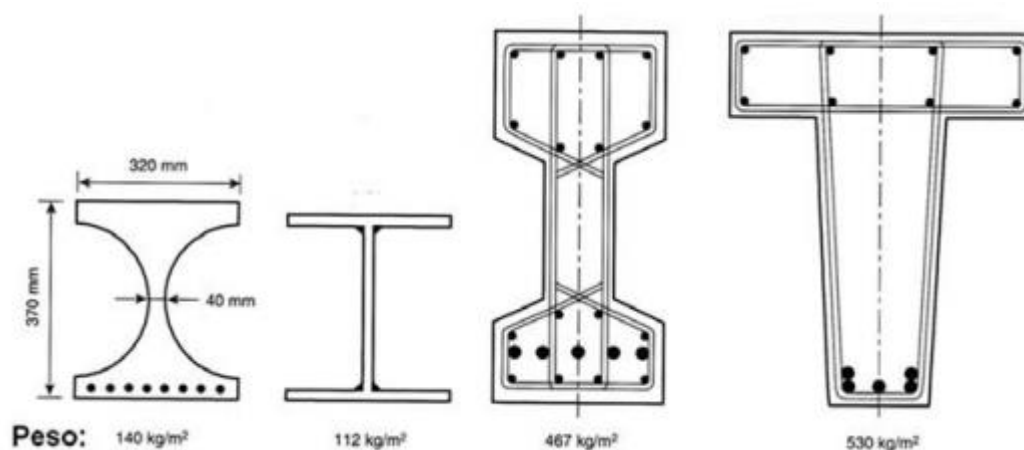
Secções de UHPC, aço, betão pré-esforçado, betão armado (WALRAVEN, 2000)
